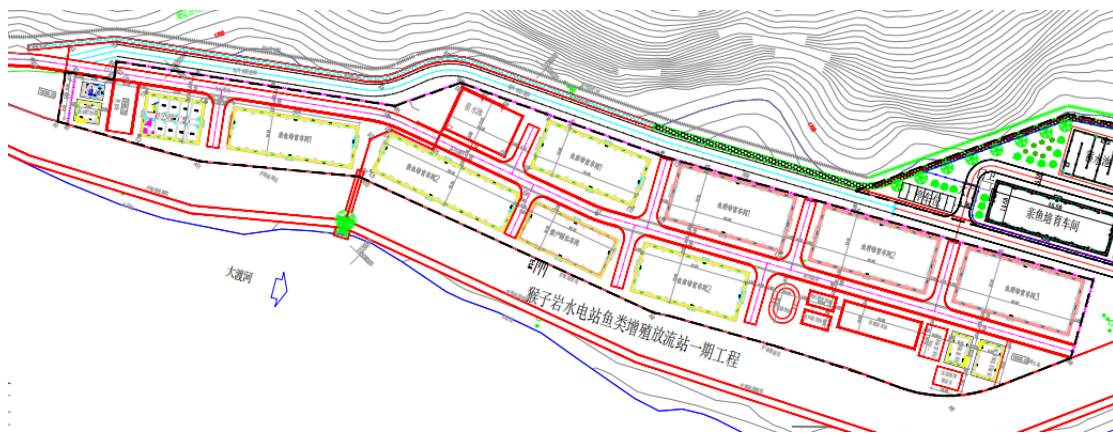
猴子岩鱼类增殖站一期工程总平面布置图
